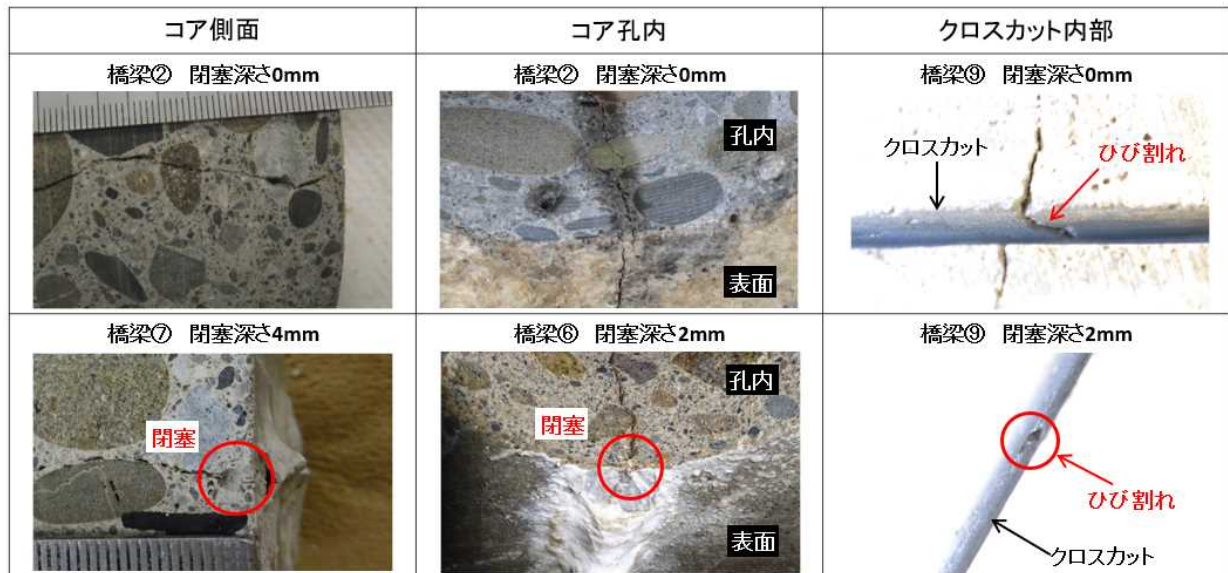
コア側面とコア孔内、およびクロスカット内部のひび割れの閉塞状況の例
